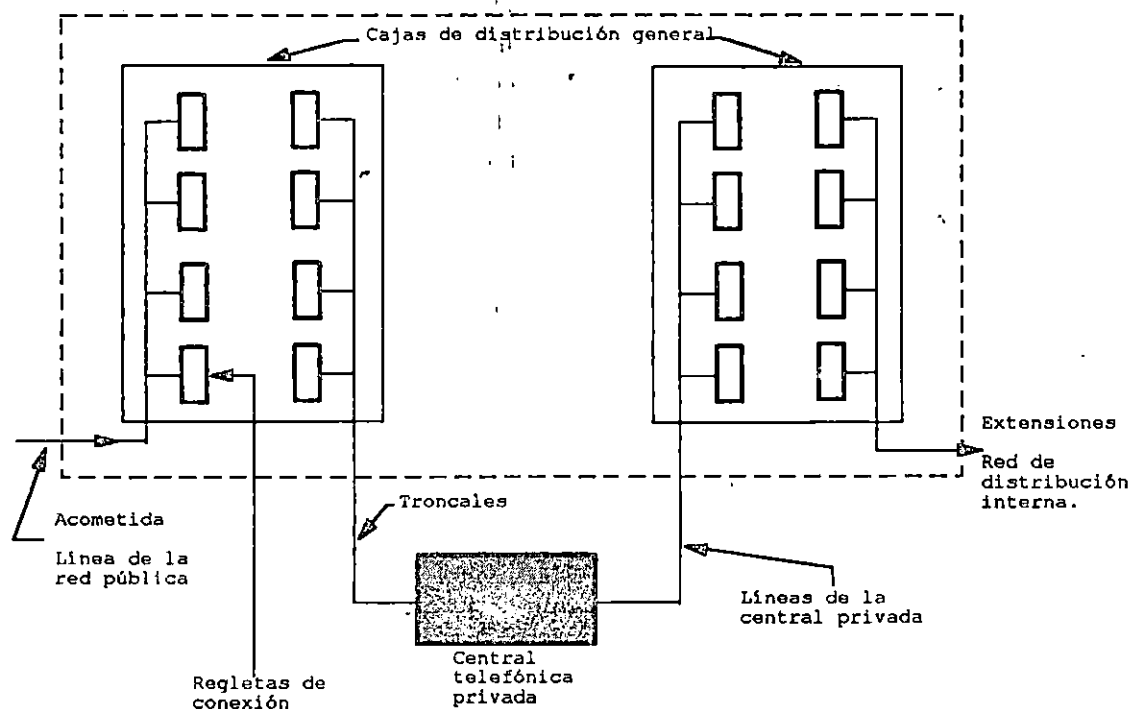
Instalación de las cajas de distribución general, en caso de que exista una central telefónica privada.
